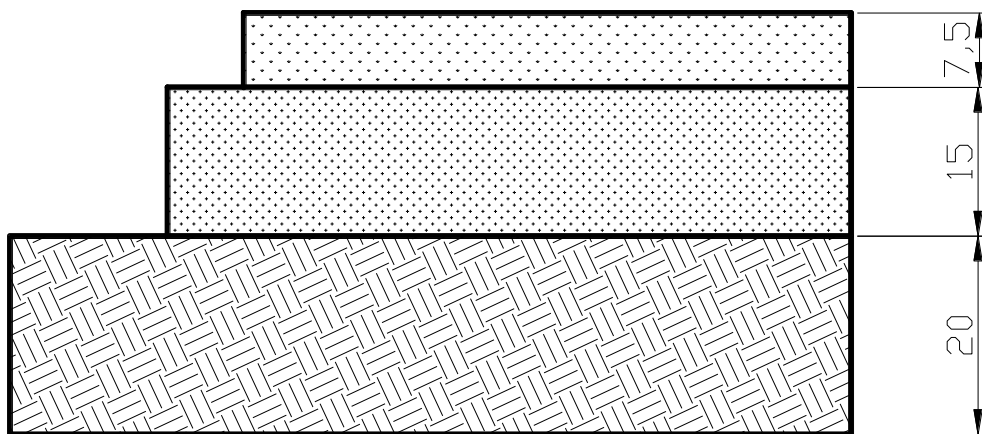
Esquema de capas de pavimento flexible del camino municipal
